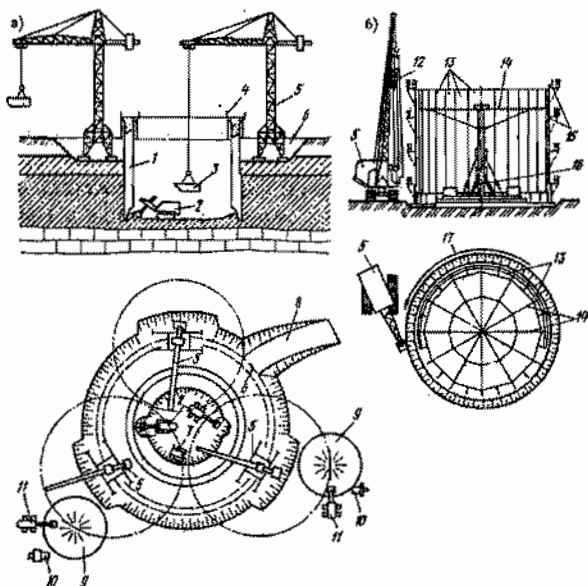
Схема устройства опускных колодцев из монолитного (а) и сборного (б) железобетона: 1 - железобетонные стены колодца с ножом; 2 - экскаватор; 3 - бадья для грунта; 4 - опалубка; 5 - кран; 6 - пионерный котлован; 7 - бульдозер; 8 - выездная трамшья; 9 - отвалы грунта; 10 - самосвалы; 11 - экскаваторы на погрузке грунта; 12 - стеновая панель с ножом; 13 - смонтированные панели колодца; 14 - кондуктор; 15 - подмости; 16 - центральная стойка кондуктора; 17 - направление установки панелей
